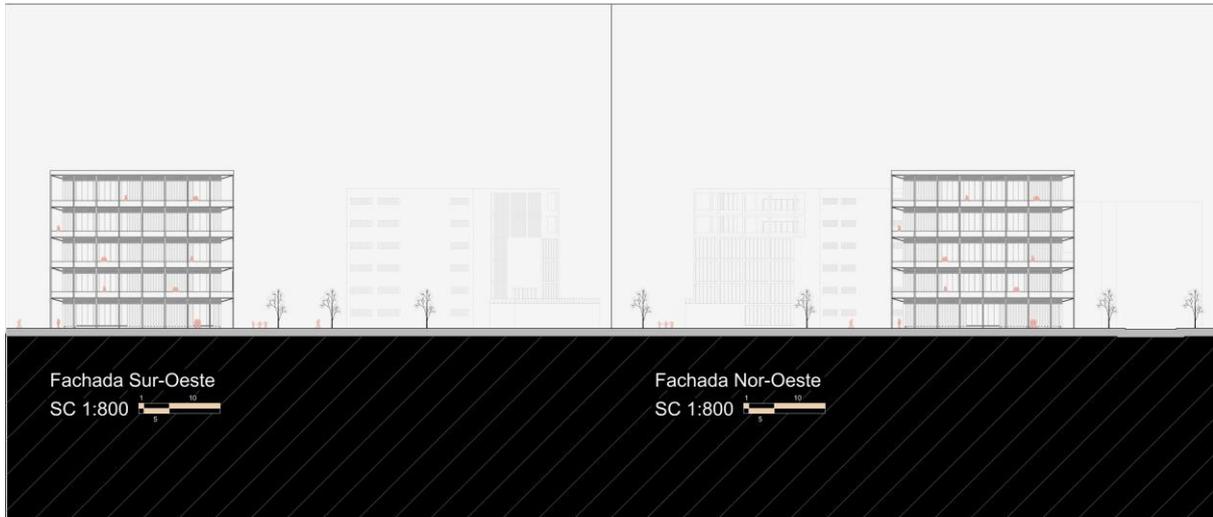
Tec. Fachadas Sur-Oeste & Nor-Oeste. Elaboración Propia
